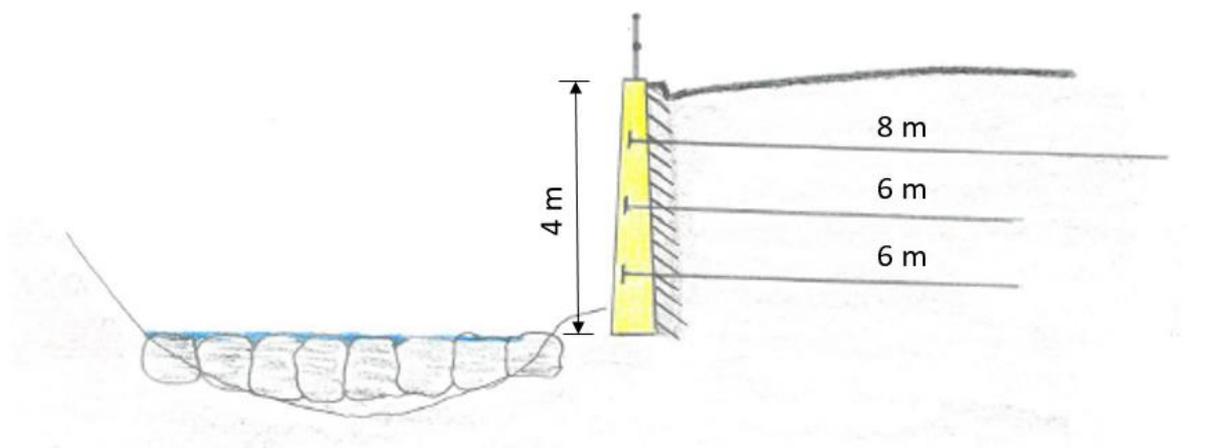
Detail Stahlbetonmauer mit Vernagelung
